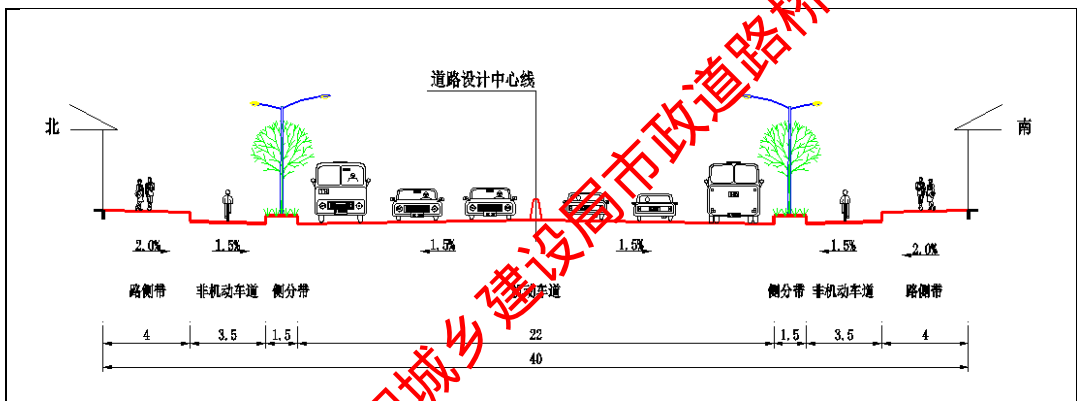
榆阳路加层桥（道路段）路基横断面示意图
